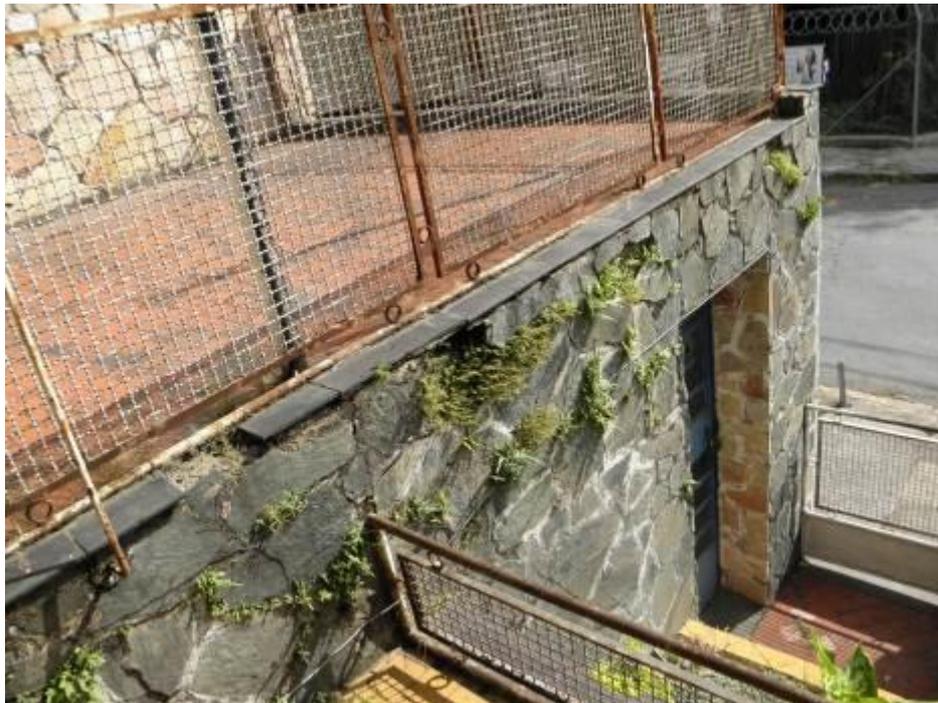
Vista da escada de acesso à garagem no lote 7
